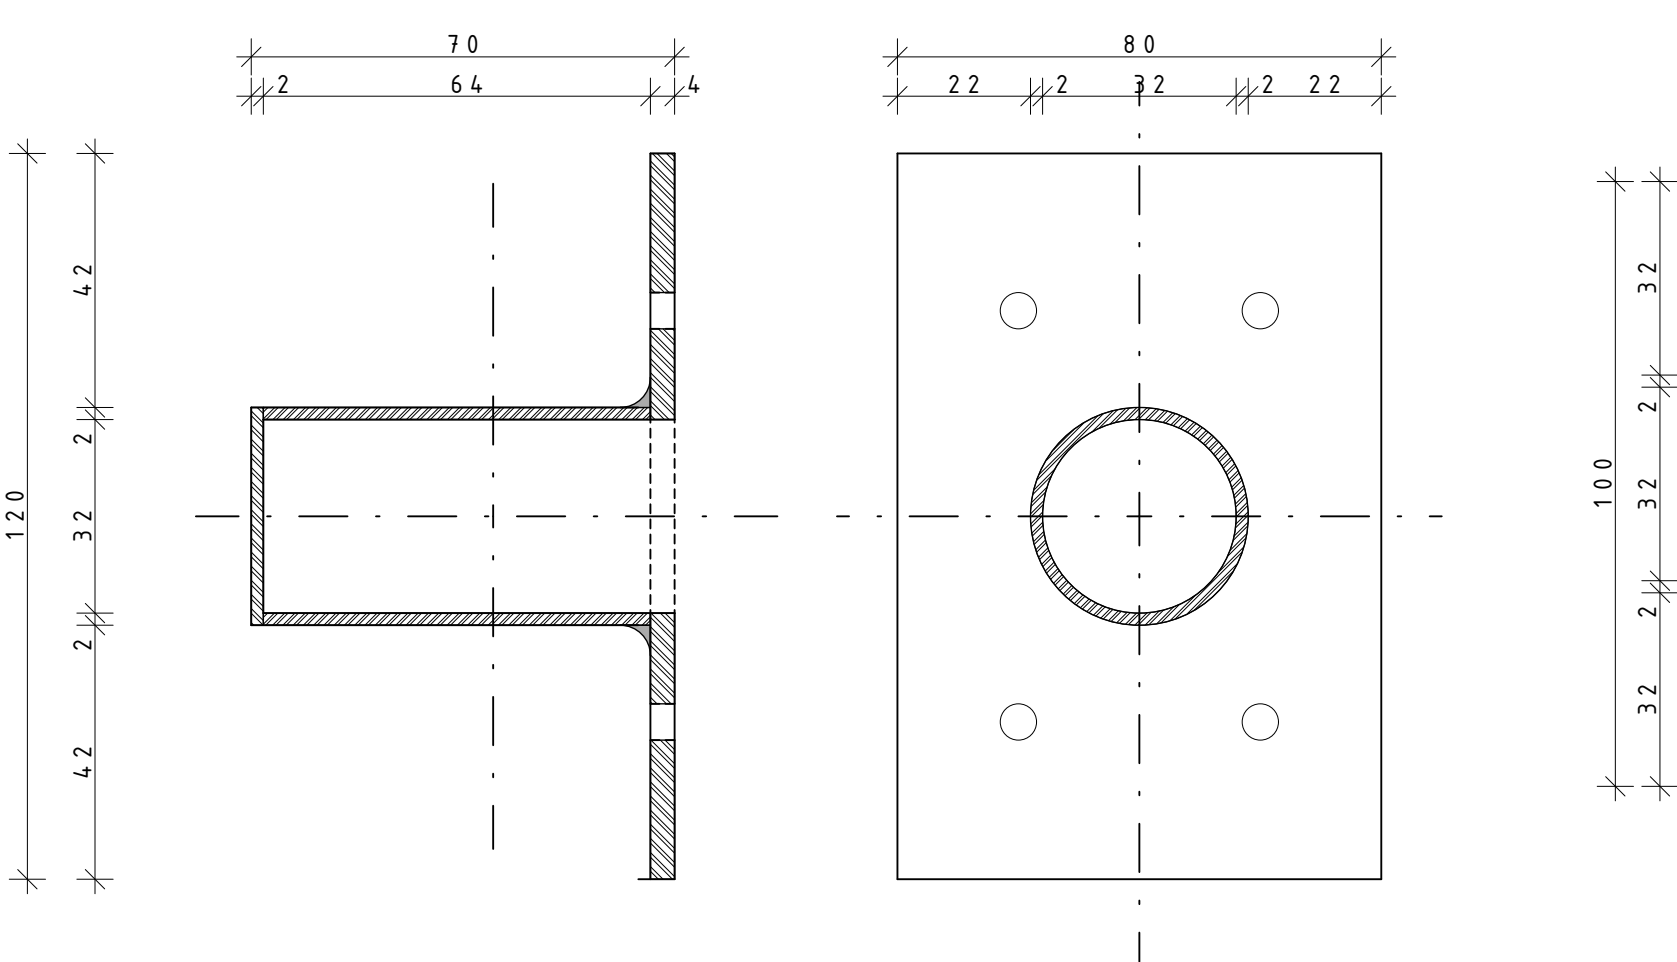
DETAIL DOLNÍHO UCHYCENÍ - M 1:2
